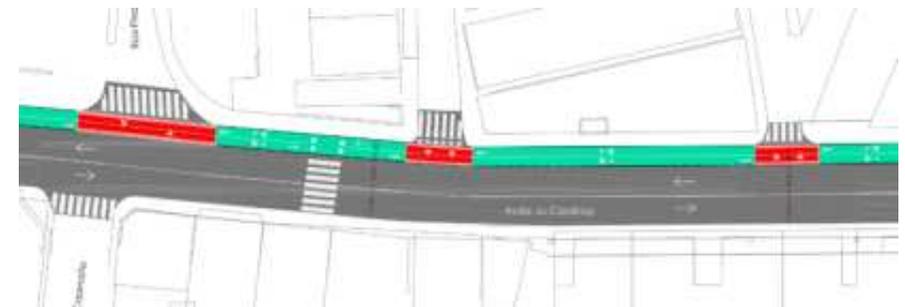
Detalle del proyecto constructivo en Avda. as Carolinas
